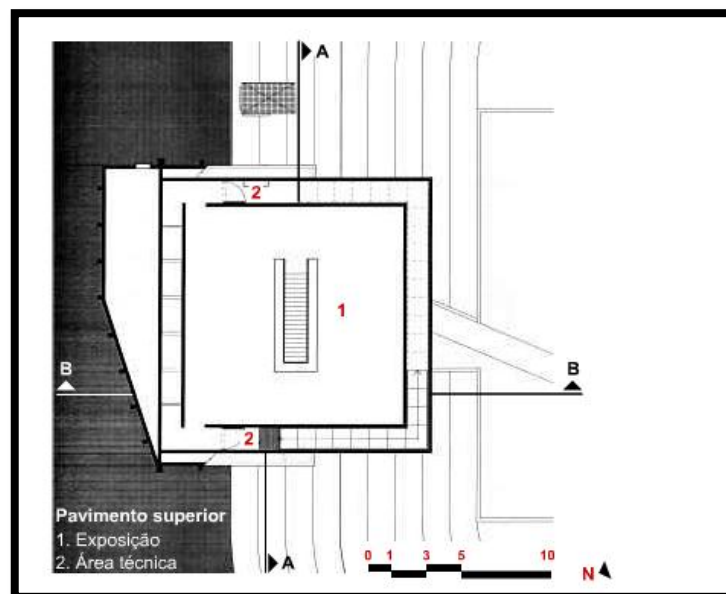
Planta Baixa primeiro pav. Galeria de Arte Adriana Varejão.
